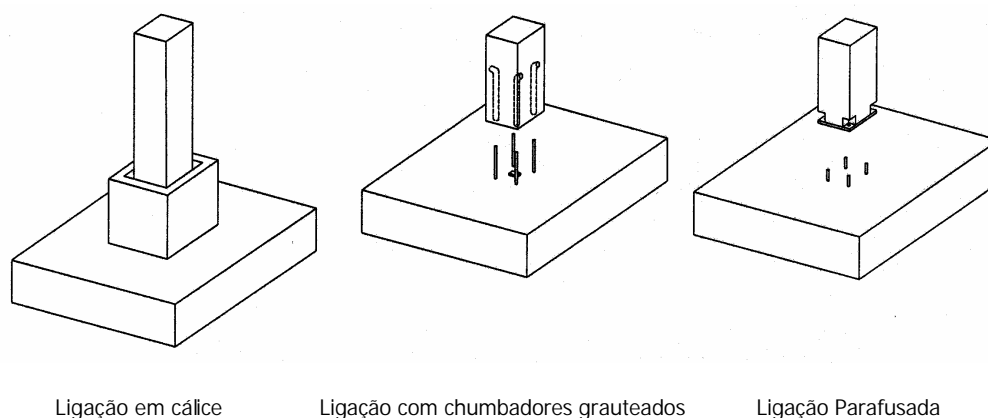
ligações engastadas entre as pilares pré-moldados e fundações
